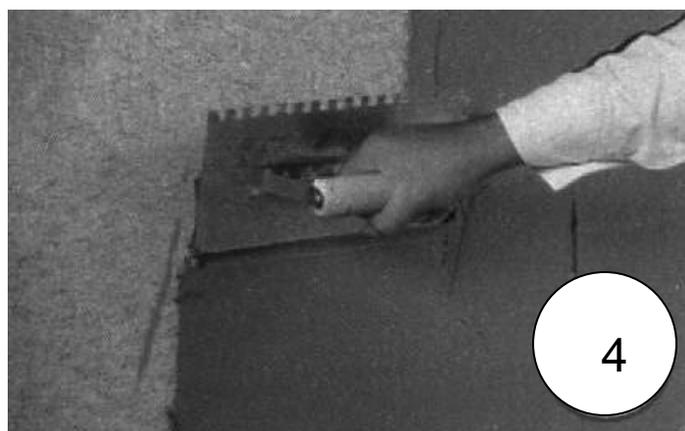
Aplicação da argamassa com o lado liso da desempenadeira.
